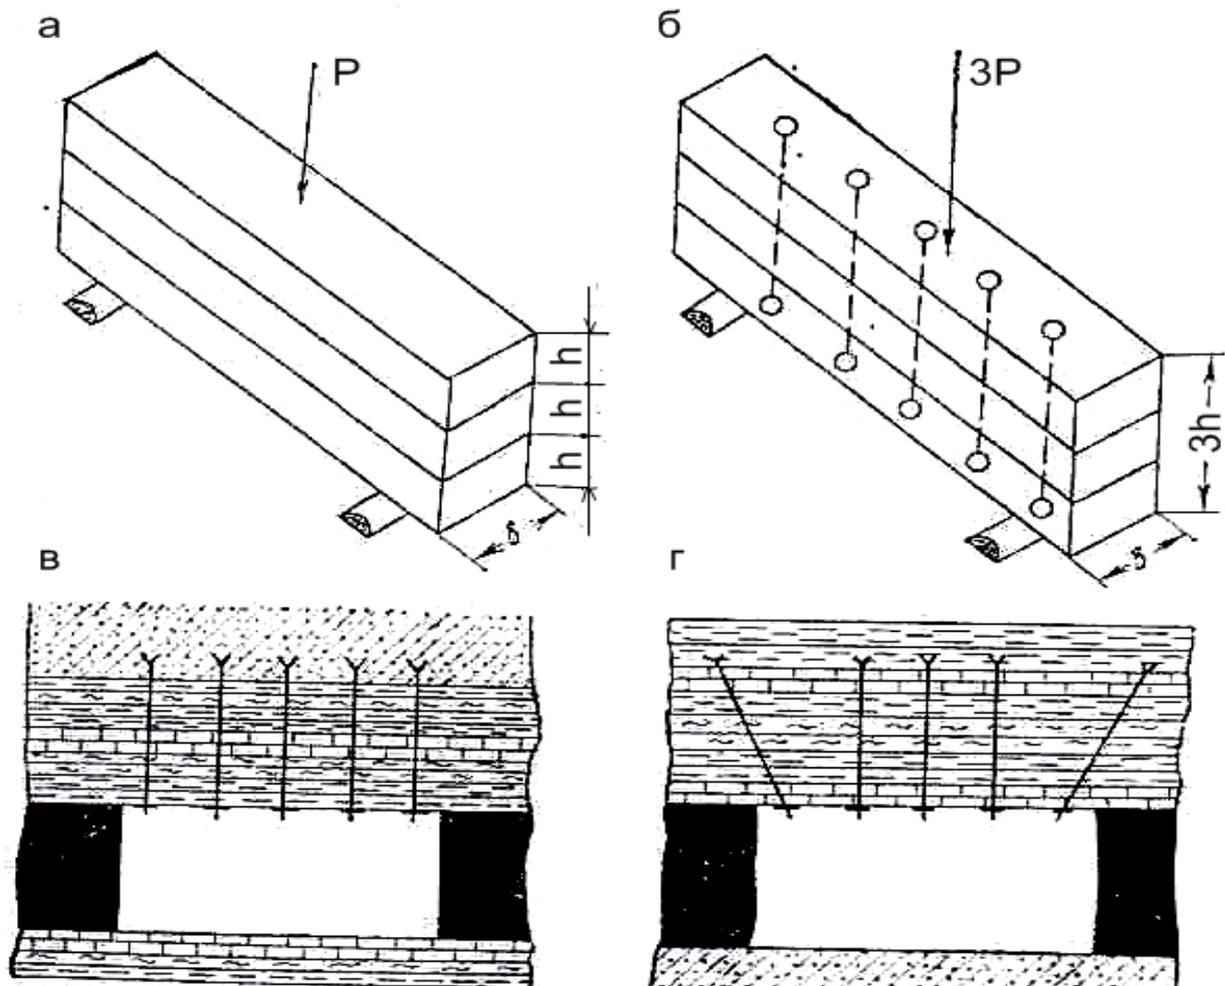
Схемы, поясняющие работу анкерной крепи:
